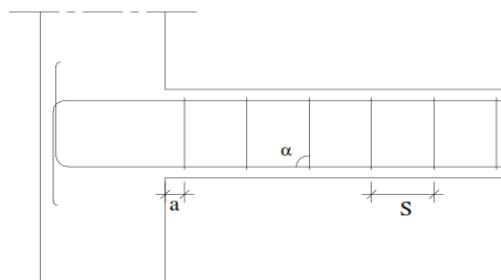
Disposição construtiva dos estribos, retirado de Martins e Ferreira (2006)
